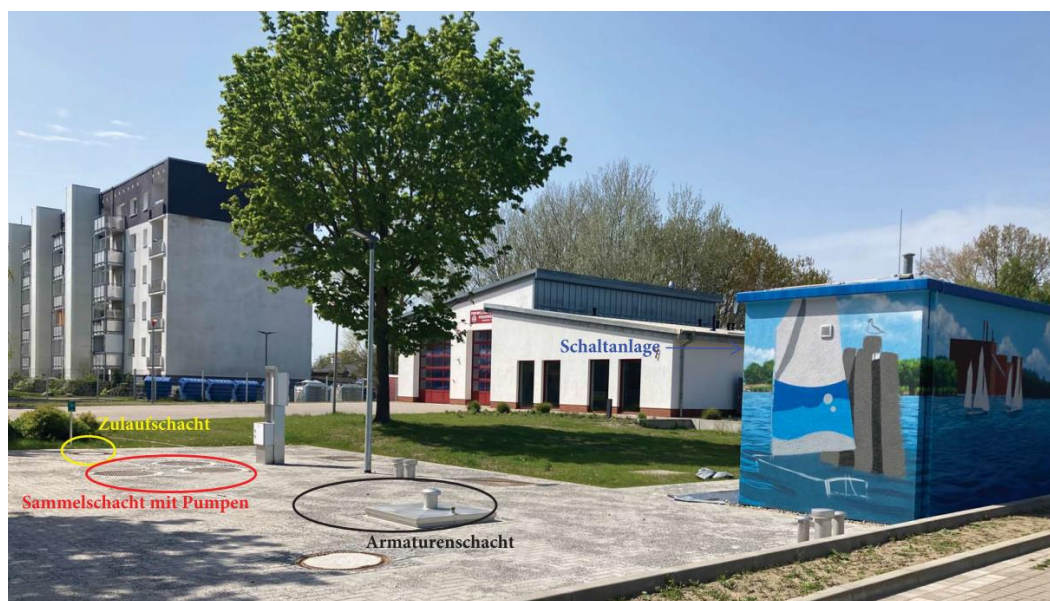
Foto des Abwasserpumpwerks (Stand: April 2024) [9]
